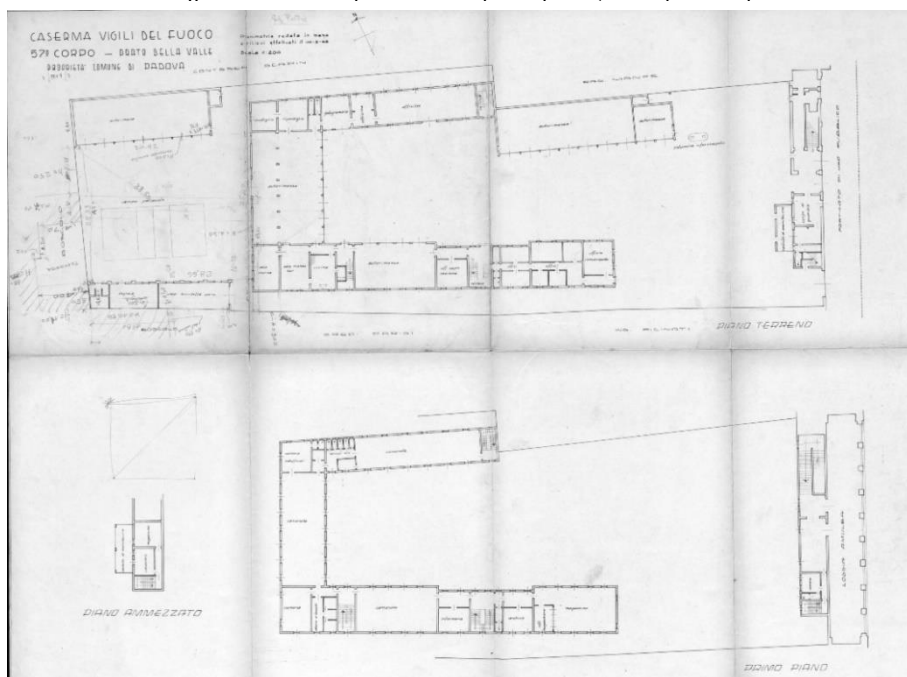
Pianta piano terra e piano primo, 1962 [AGCPd].
